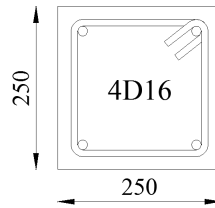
Contoh Salah Satu Detail Penulangan Balok (B1 Interior).
